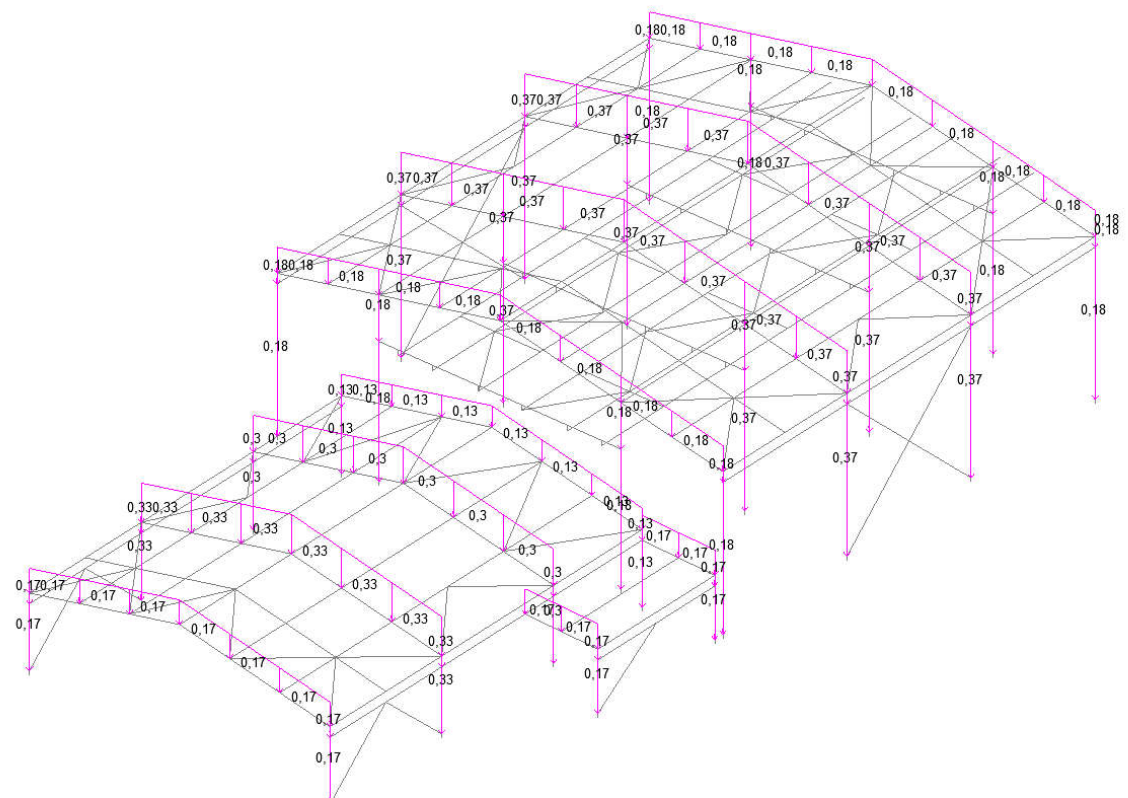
Схема приложения нагрузки L6 «Нагрузка от промпроводки»
